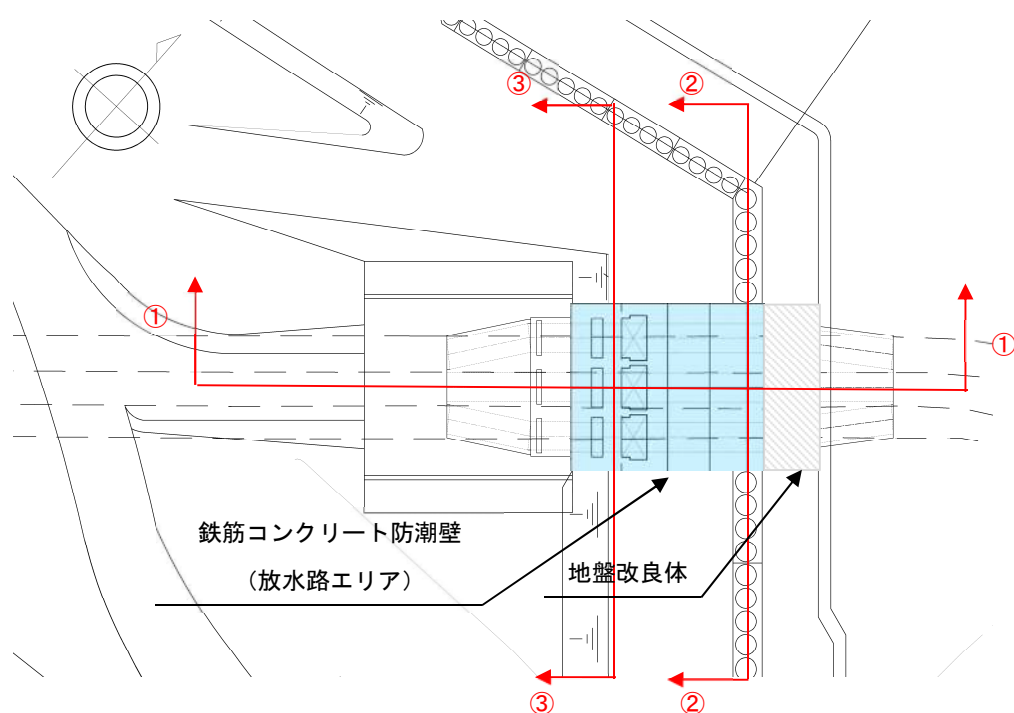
鉄筋コンクリート防潮壁（放水路エリア）の平面図
